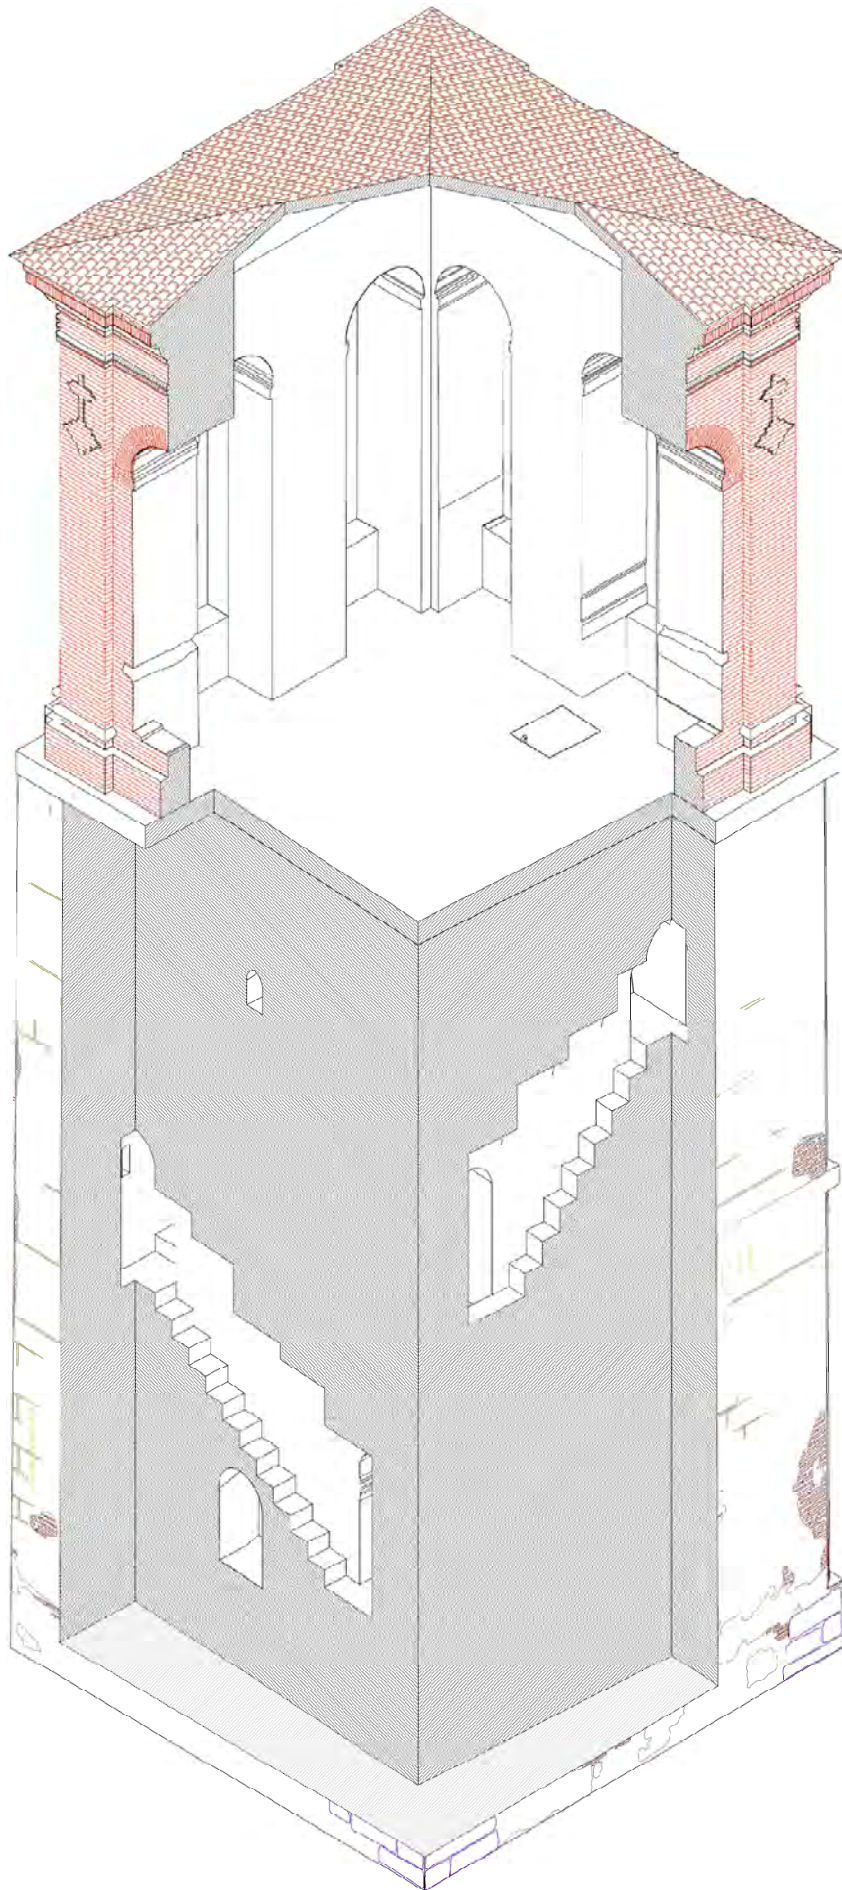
axonometría seccionada del estado actual de la torre de Aldeaseca. Se secciona por la mitad del espesor del muro para poder observar cómo se encastran las escaleras en éste.
